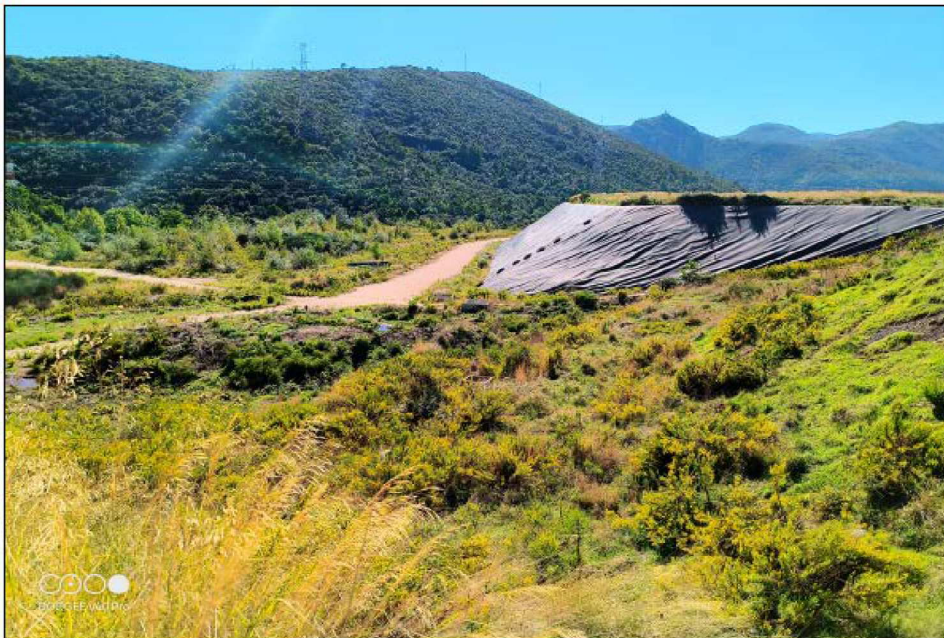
Esistente impermeabilizzazione zona deposito scorie
